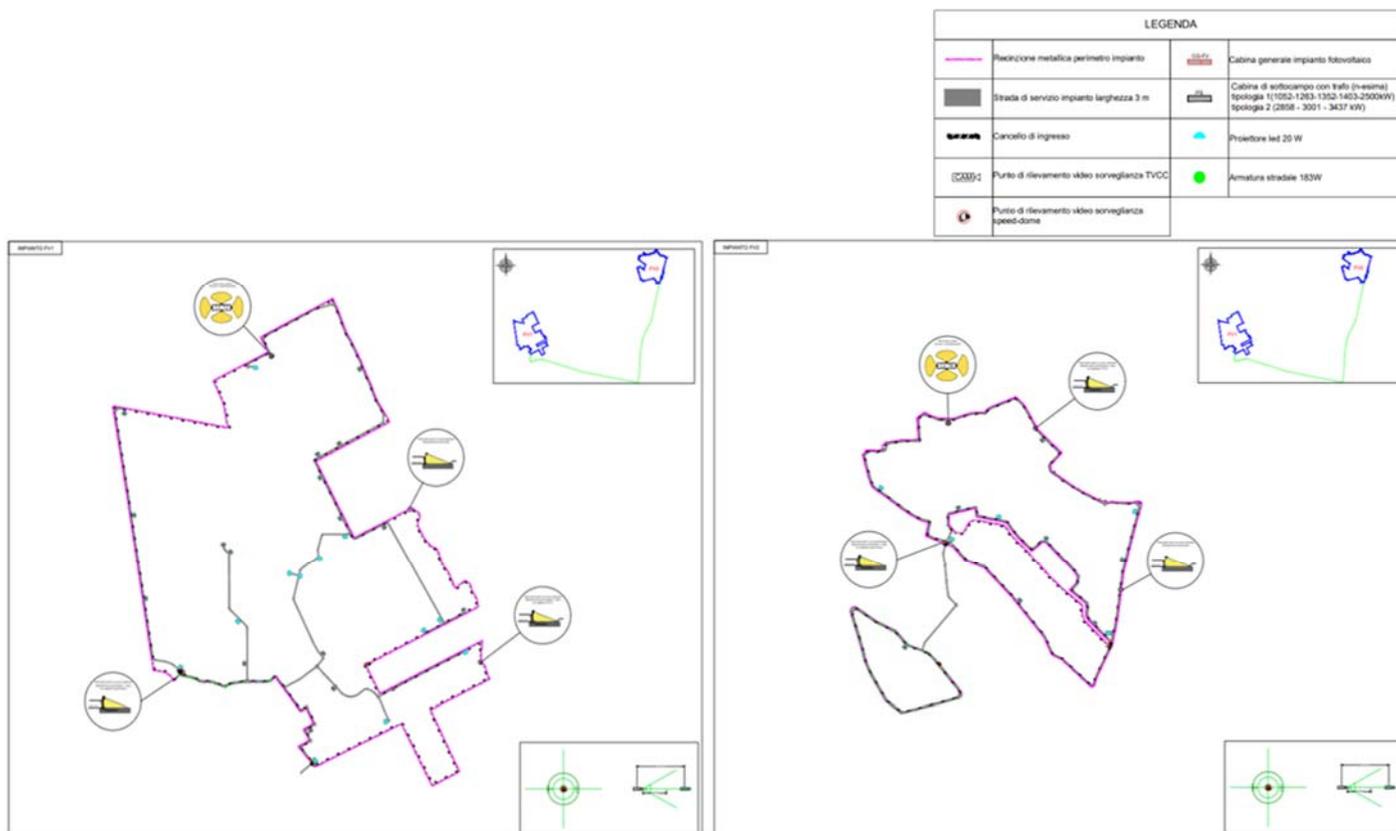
Layout impianto fv: impianto illuminazione e videosorveglianza
